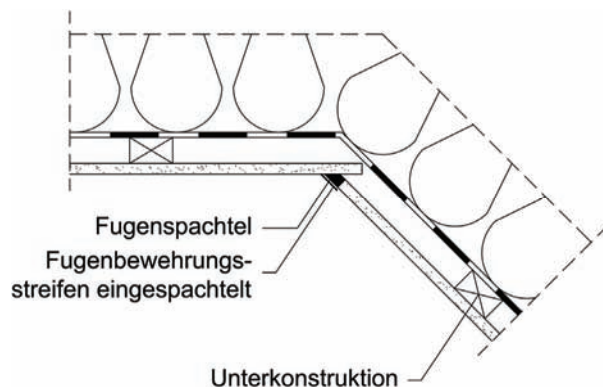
Anschlussdetail einer Dachschräge mit einer Decke mit stumpf eingespachteltem Bewehrungsstreifen nach [ÖNORM B 2320]
